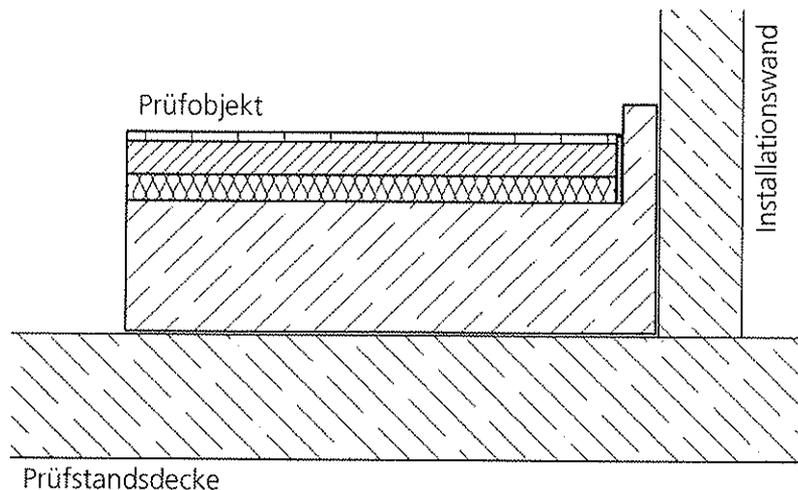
Schnittzeichnung des Prüfaufbaus im Installationsprüfstand P12 des IBP (ohne Maßstab).
